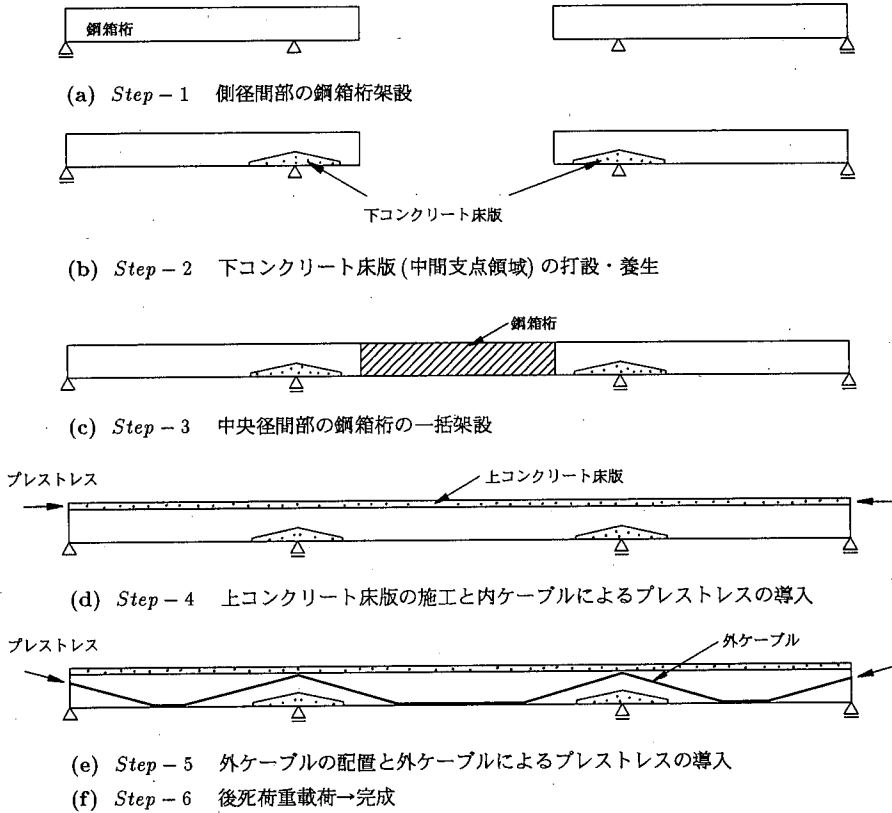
内・外ケーブルを有する鋼・コンクリート二重合成連続箱桁橋の施工手順の一例
